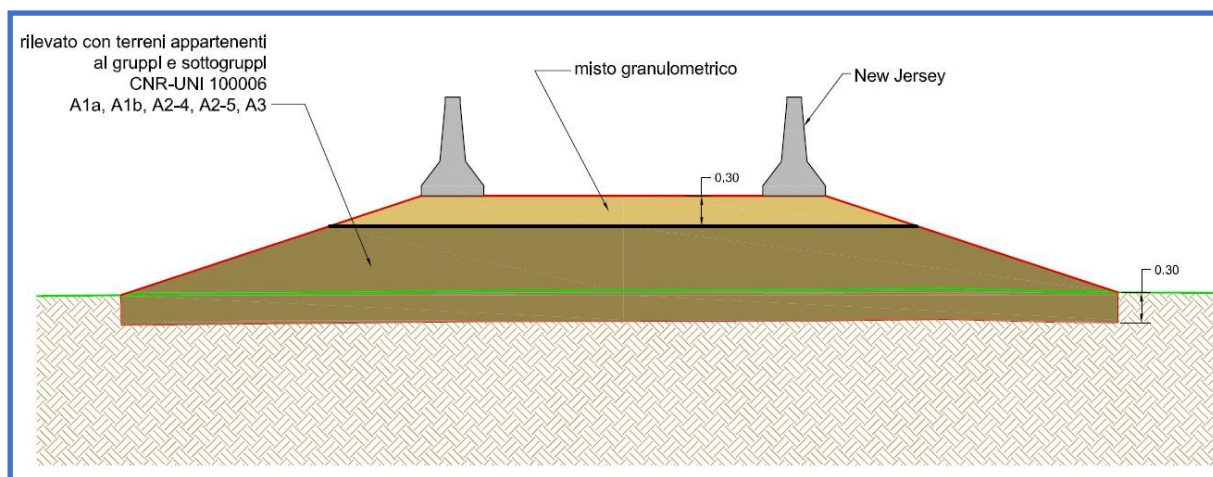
Zona intervento 4 – Sezione tipo della pista provvisoria
